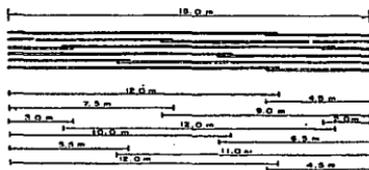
Secuencia de utilización de varillas de 12 m de longitud y 1/2" en un armado de 16 m de longitud
